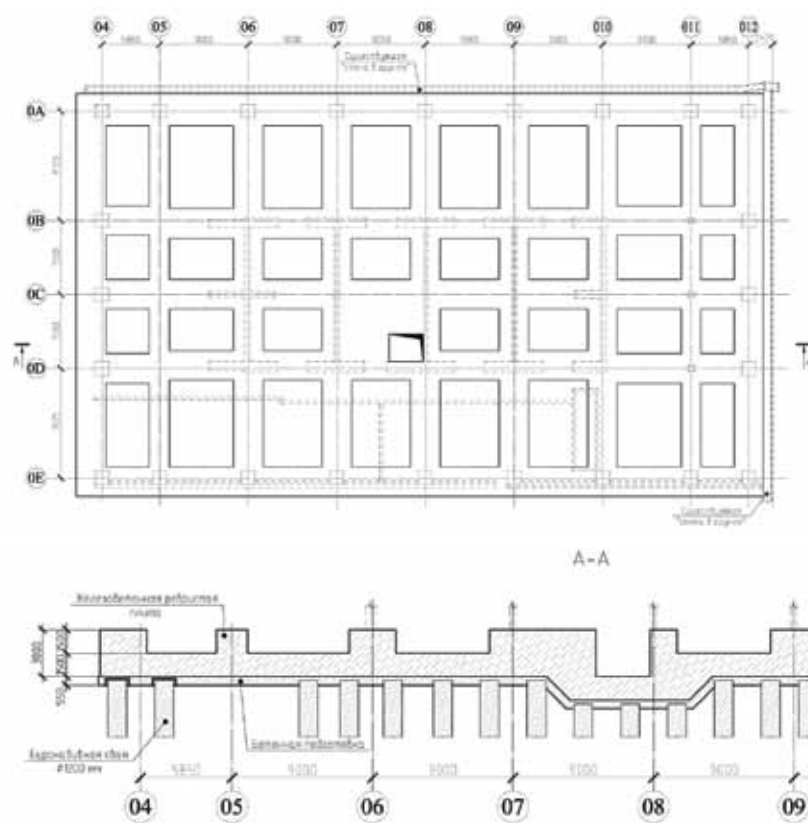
План и разрез по ребристой плите ростверка 49-этажного здания
